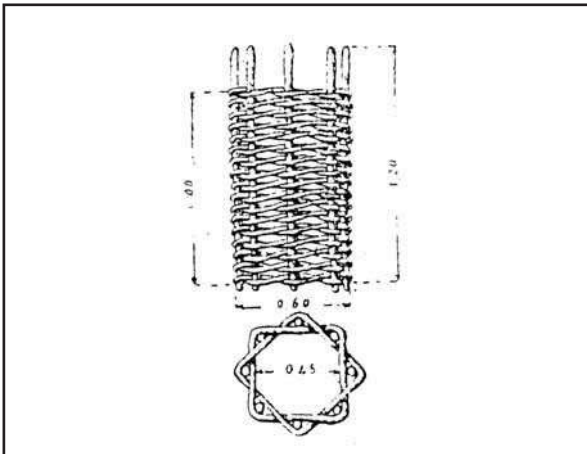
Gabbione (Stralcio dell'istruzione sui lavori da zappatore - Scuola di applicazione di fanteria 1932)
